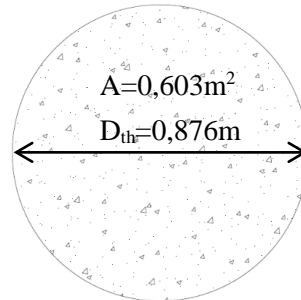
Sección del tapón de hormigón para la conexión con pilote vertical.
